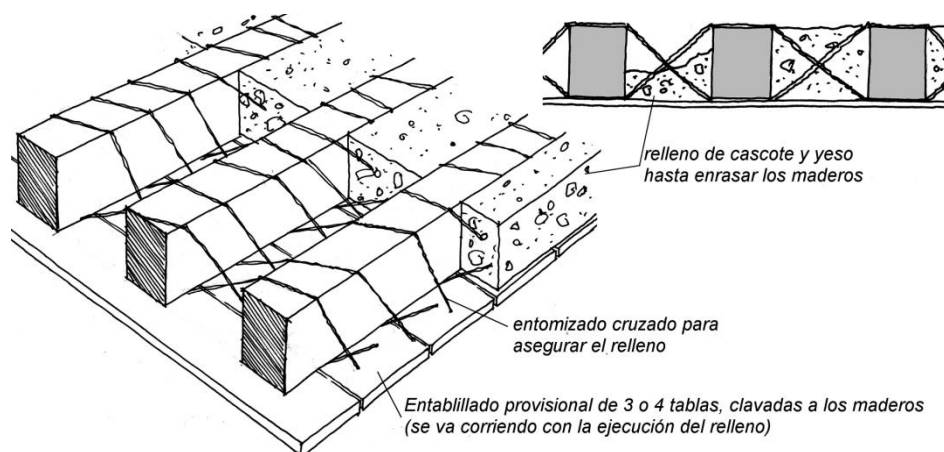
Entrevigado macizo de yeso aligerado con cascote
